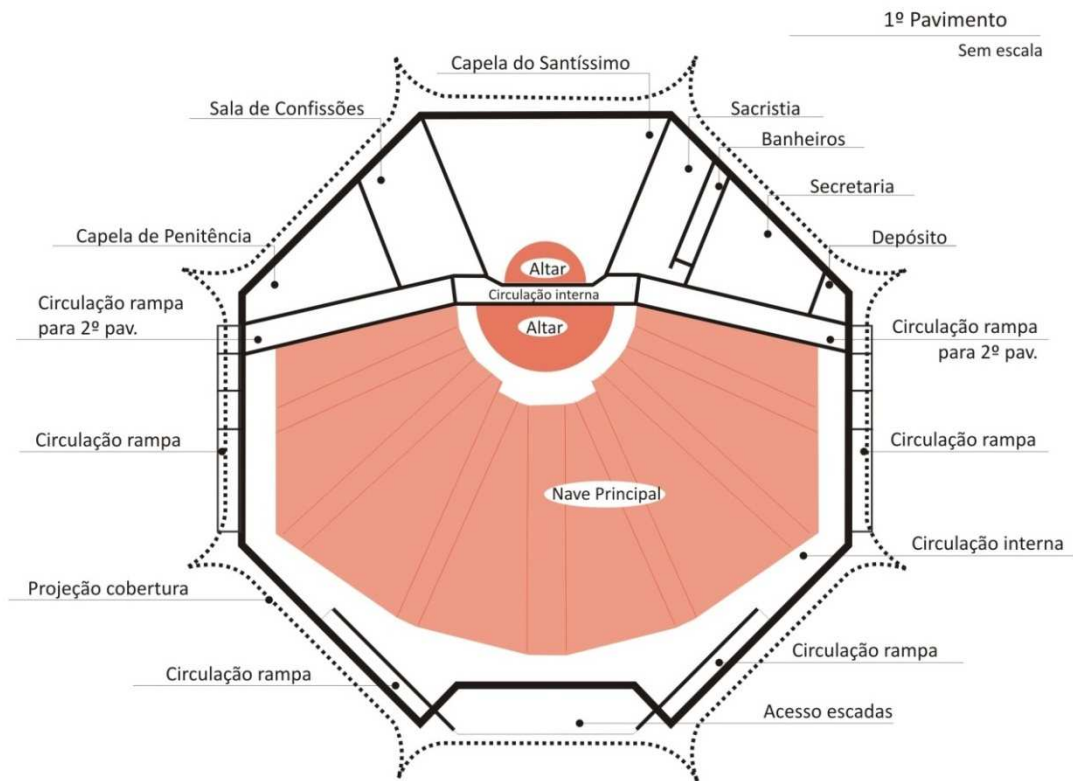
Proposta do 2º projeto - Planta esquemática do novo santuário - 1º pavimento.
